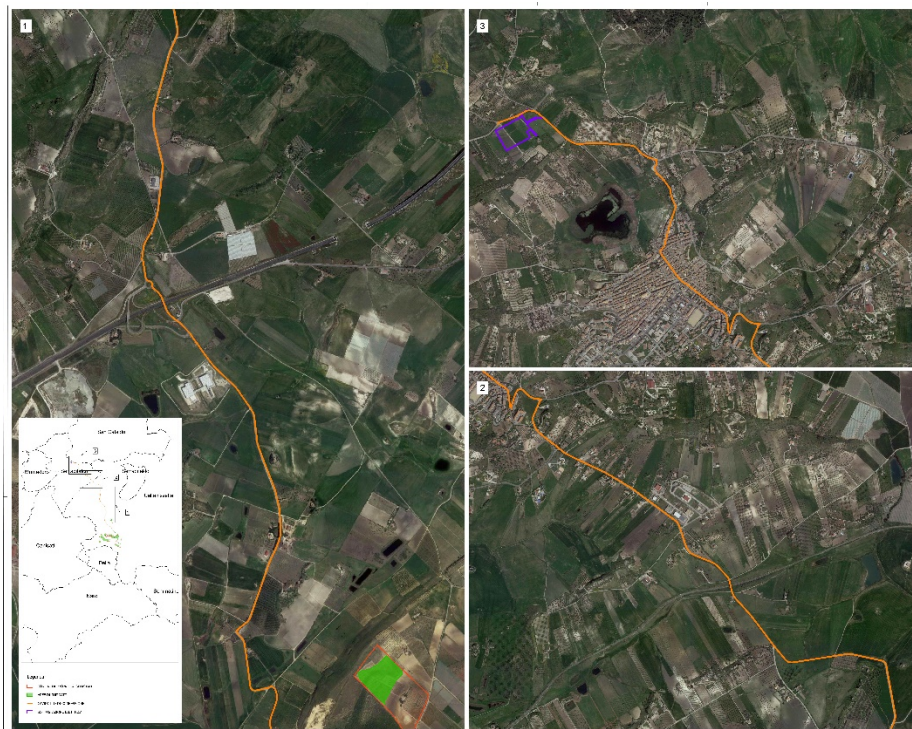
Layout del cavidotto e delimitazione delle particelle che ospitano la stazione elettrica su ortofoto
